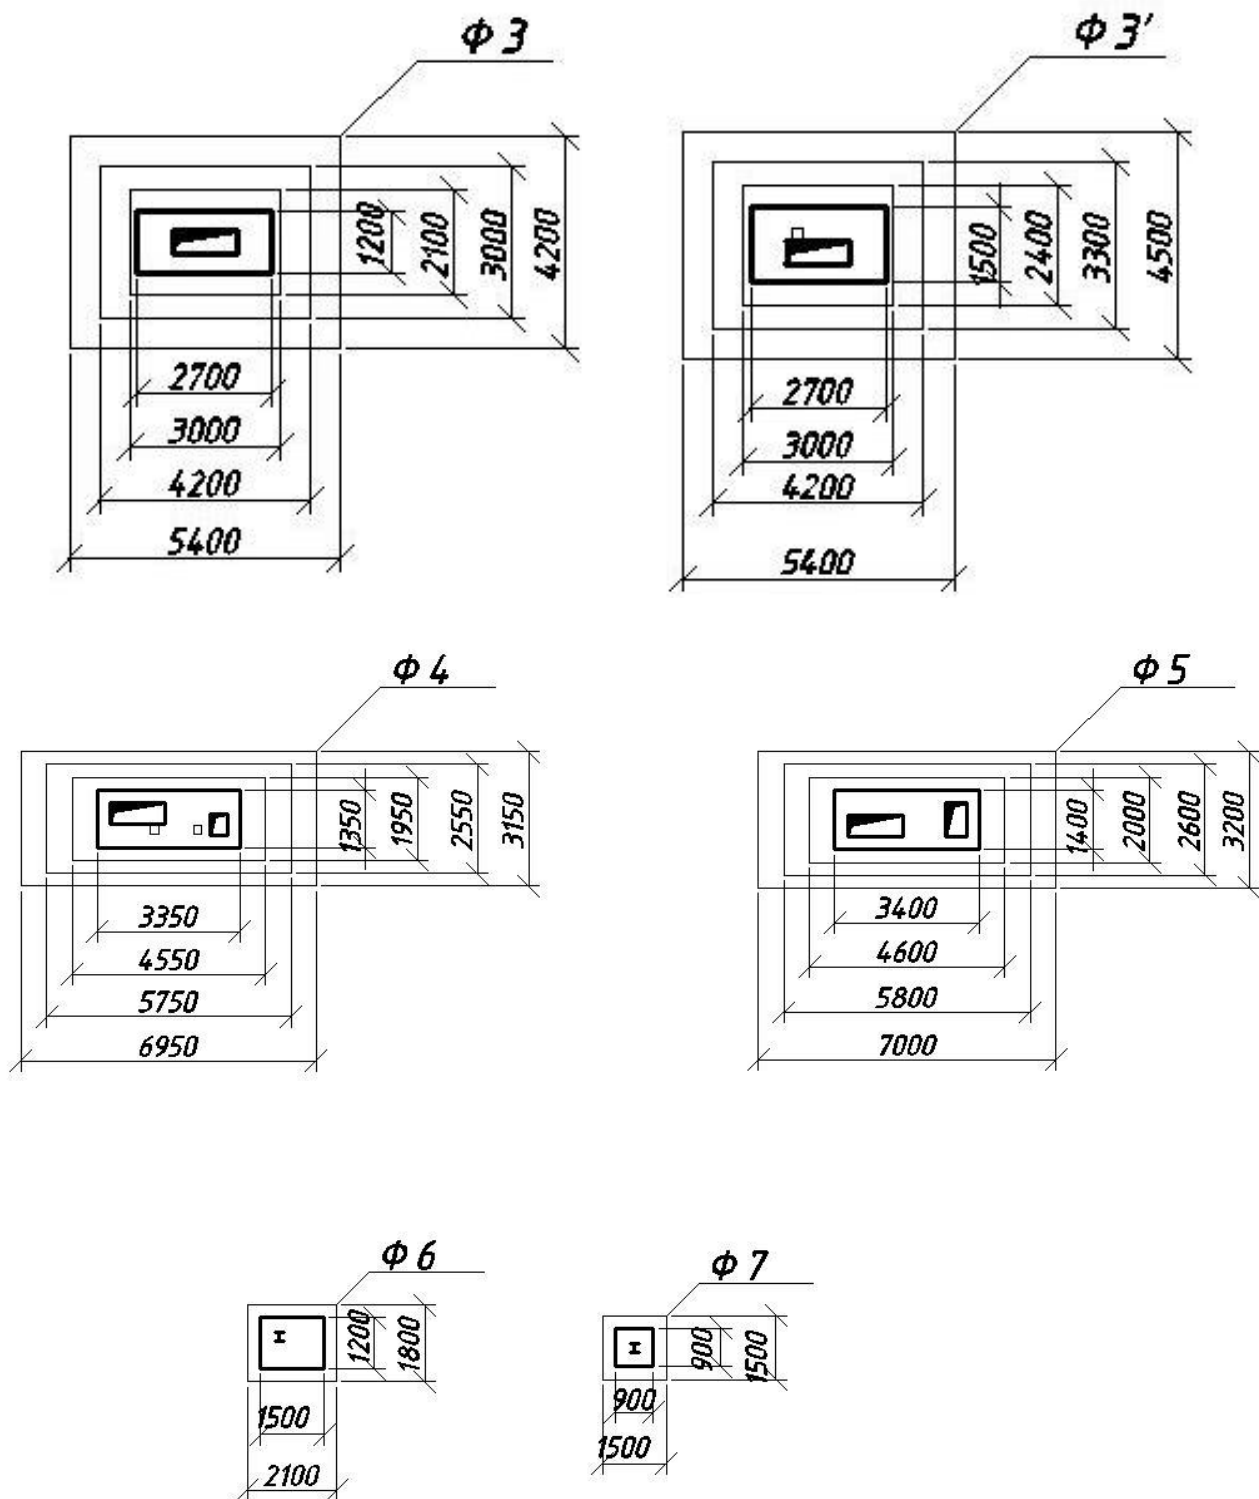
Схема залізобетонних фундаментів під колони стаканного типу
